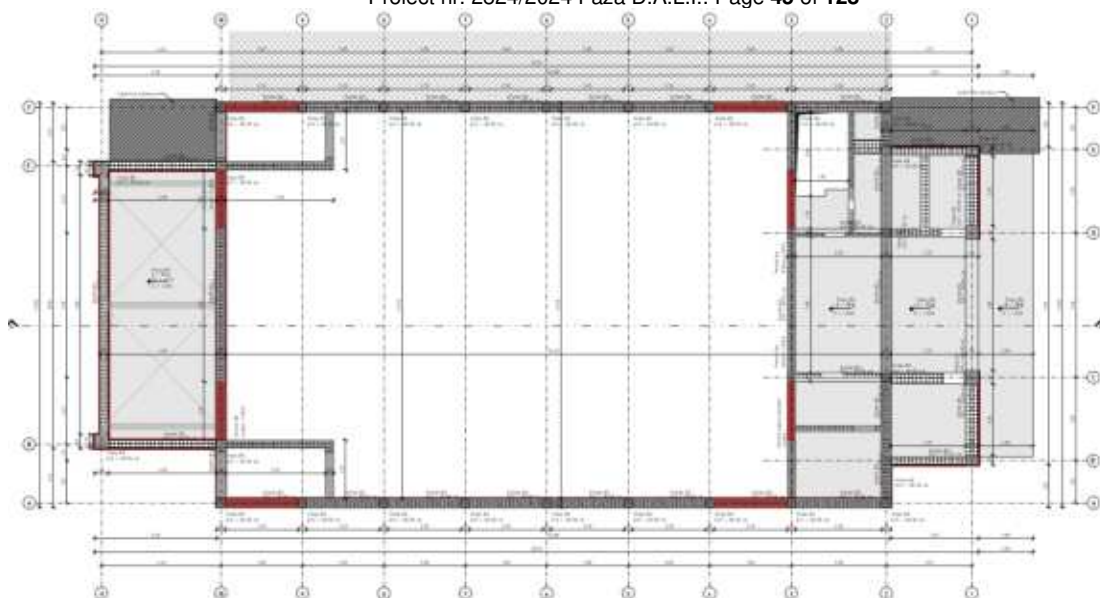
Dispunere pereti de beton armat (marcati cu rosu pe plan)
